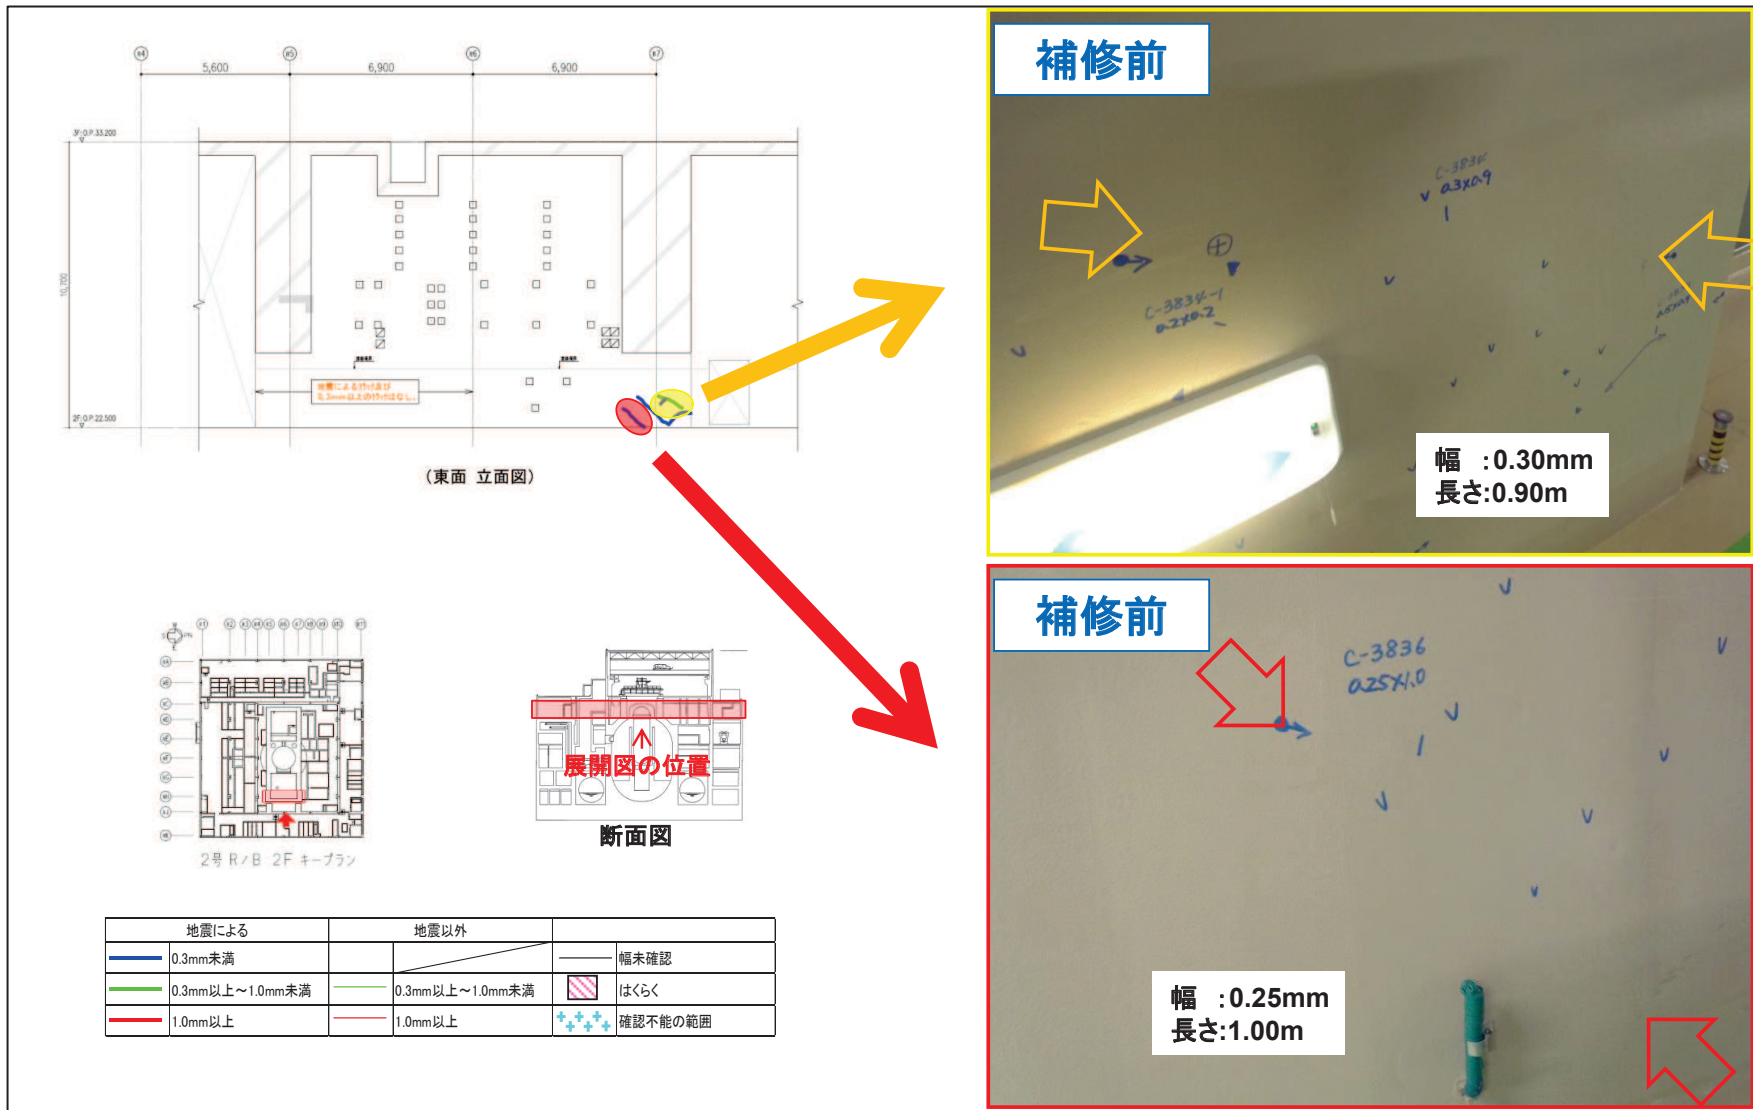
鉄筋コンクリート躯体のひび割れの例 (原子炉建屋地上 2 階)
